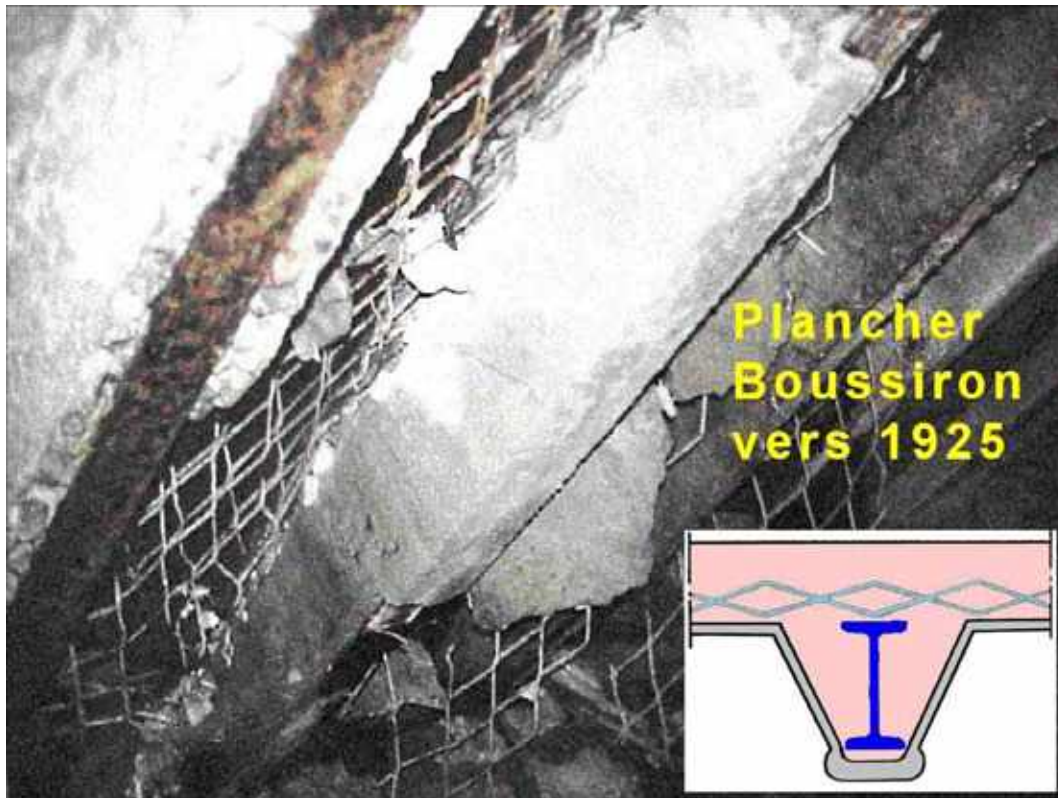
plancher Boussiron (crédit photo Jean-Paul Persy)
